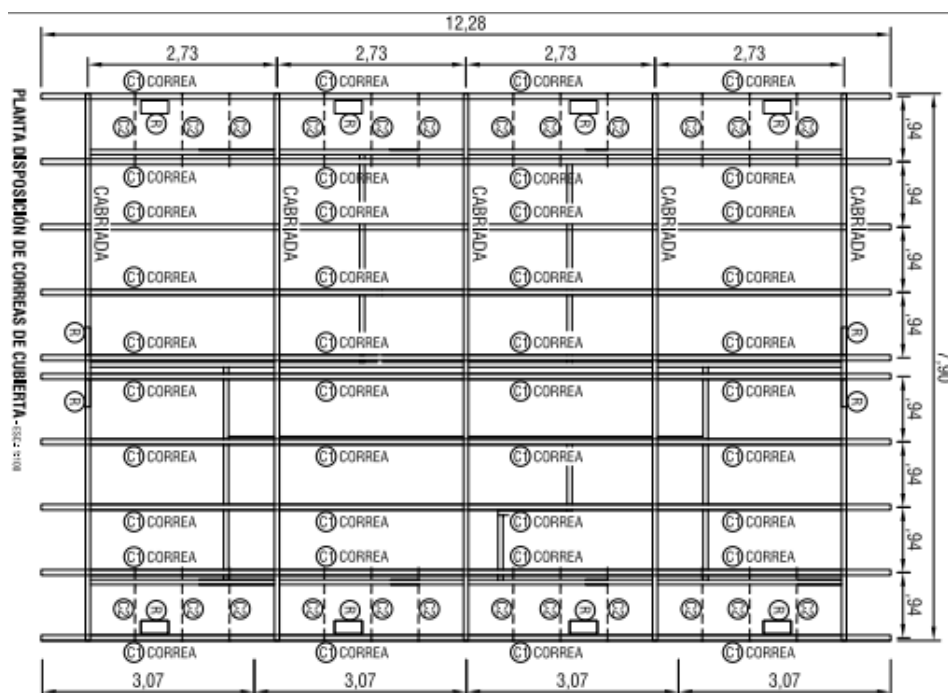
Planta de disposición de cabreadas armadas con dos medias cabreadas adosadas.
